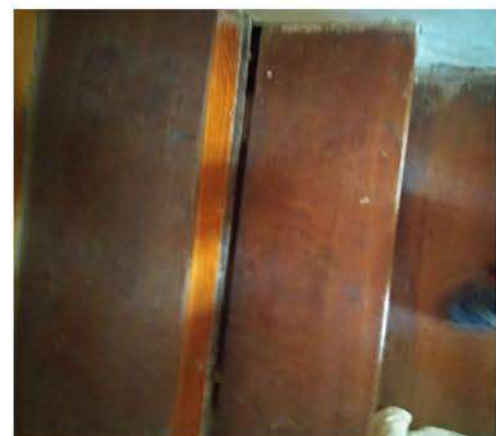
Imagen de las escaleras entre planta primera y planta segunda Fuente: Foto propia
